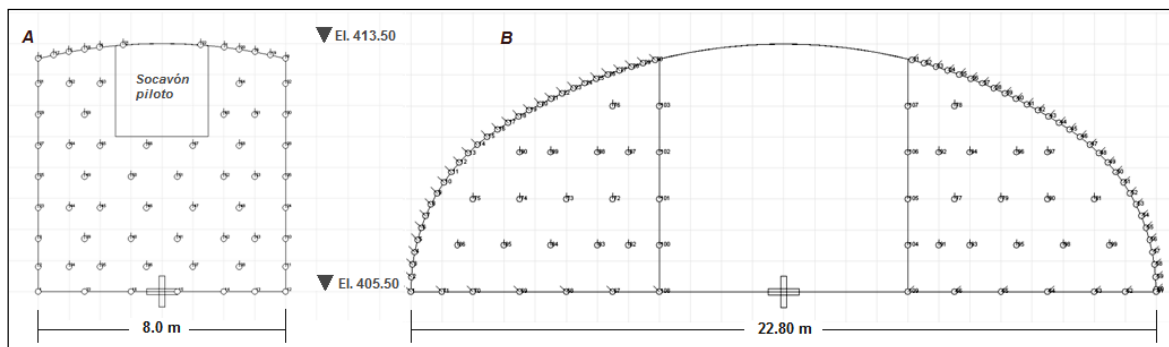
Plantillas de perforación utilizadas en la bóveda de la Casa de Máquinas. A. Zona central de la bóveda; B. Zonas laterales de la bóveda.
